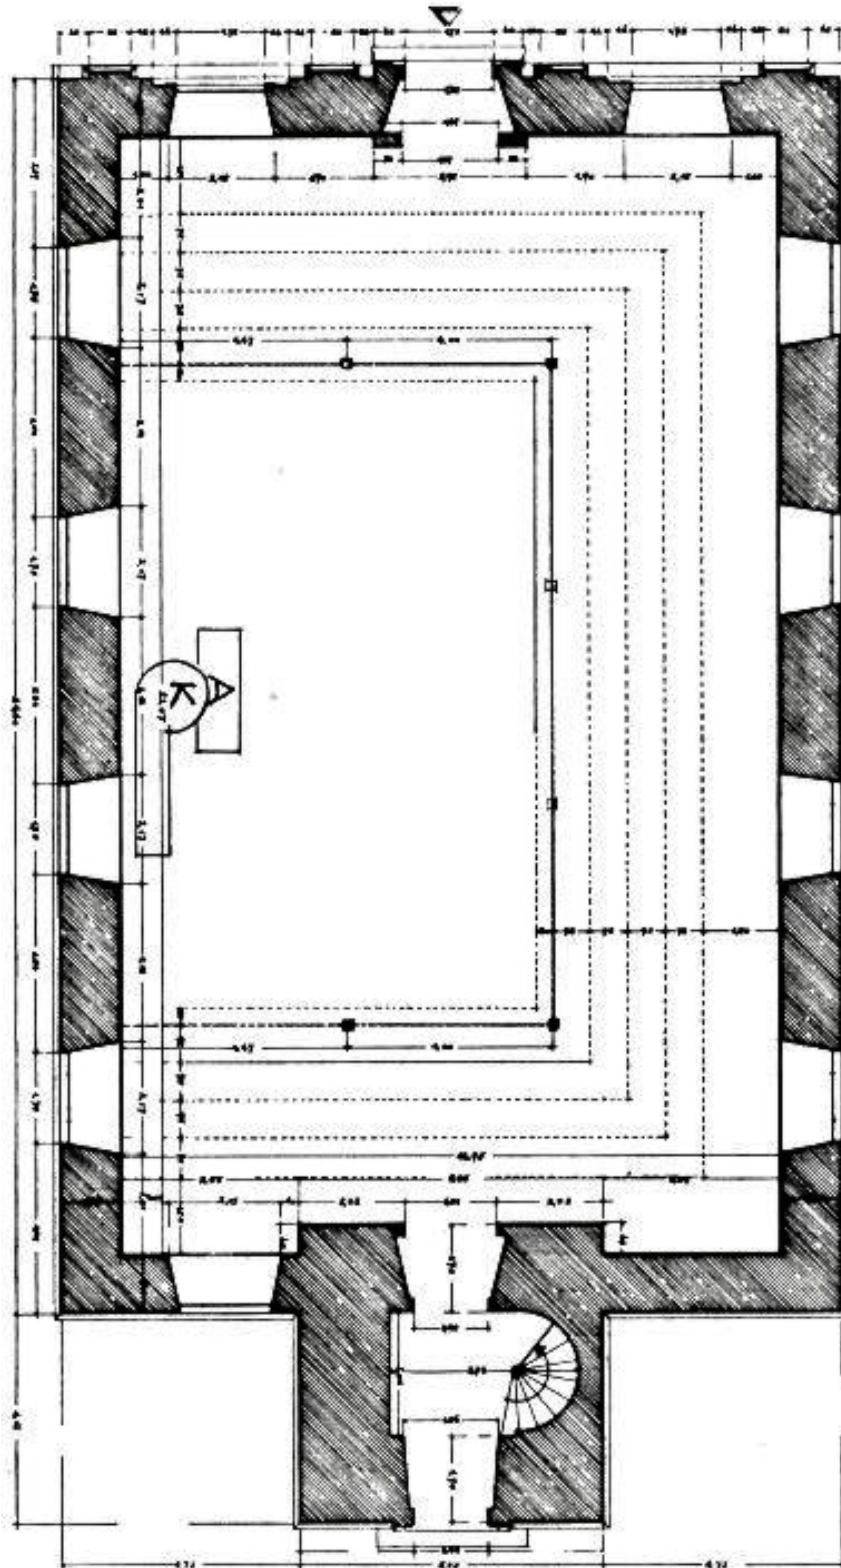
Neanderkirche Düsseldorf (1687), Grundriss Emporengeschoss
